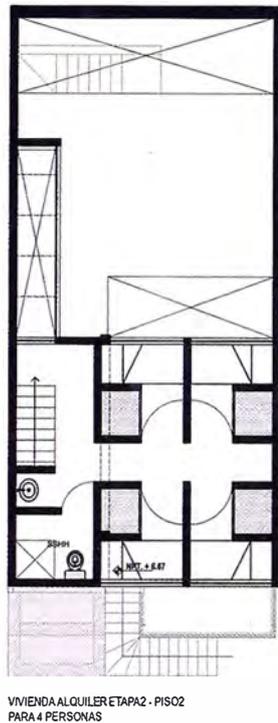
Etapa 2: Planta Vivienda-Alquiler.
